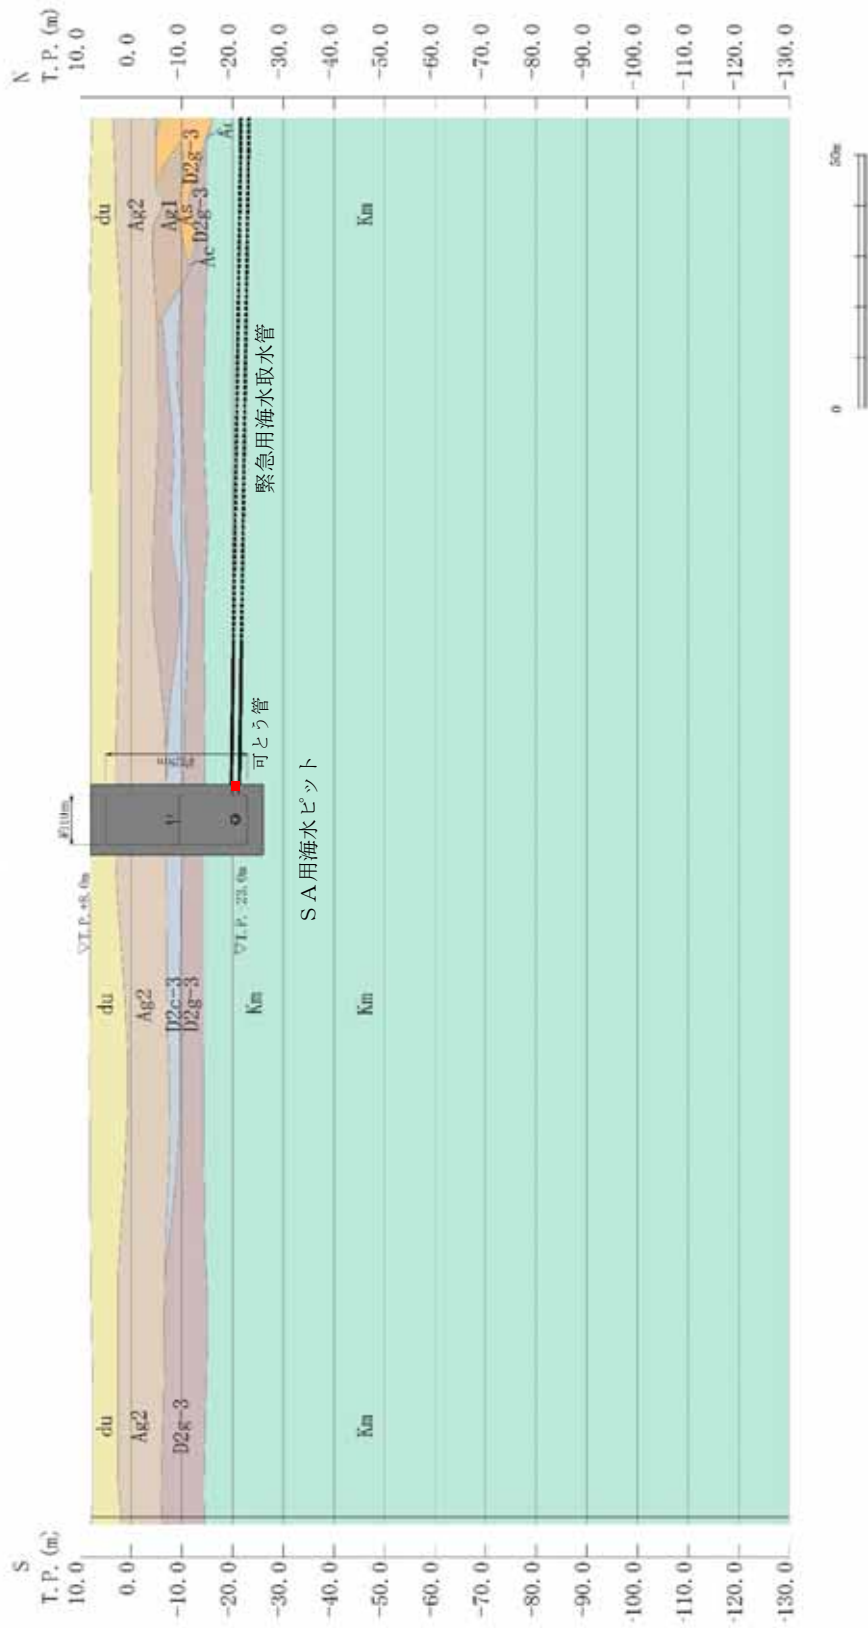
(2) SA用海水ピット 評価対象断面図 (②-②断面)
